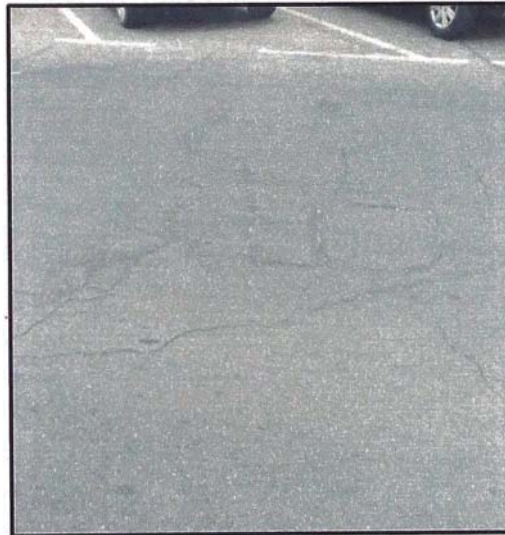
Grietas de bloque nivel medio.
